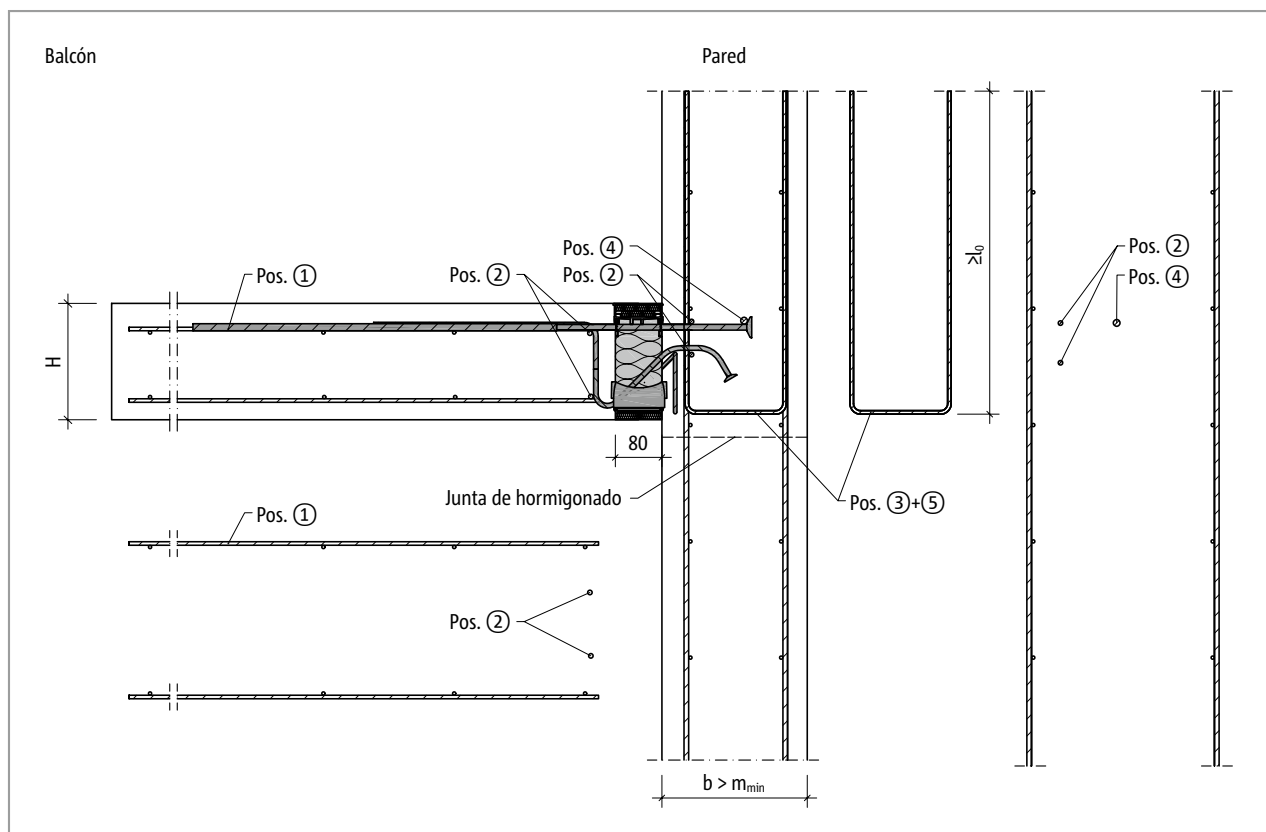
Schöck Isokorb® T tipo K-U: Armadura in situ para conexión a pared hacia arriba con dimensión mayor del elemento constructivo ($m_{exist} > m_{min}$)
